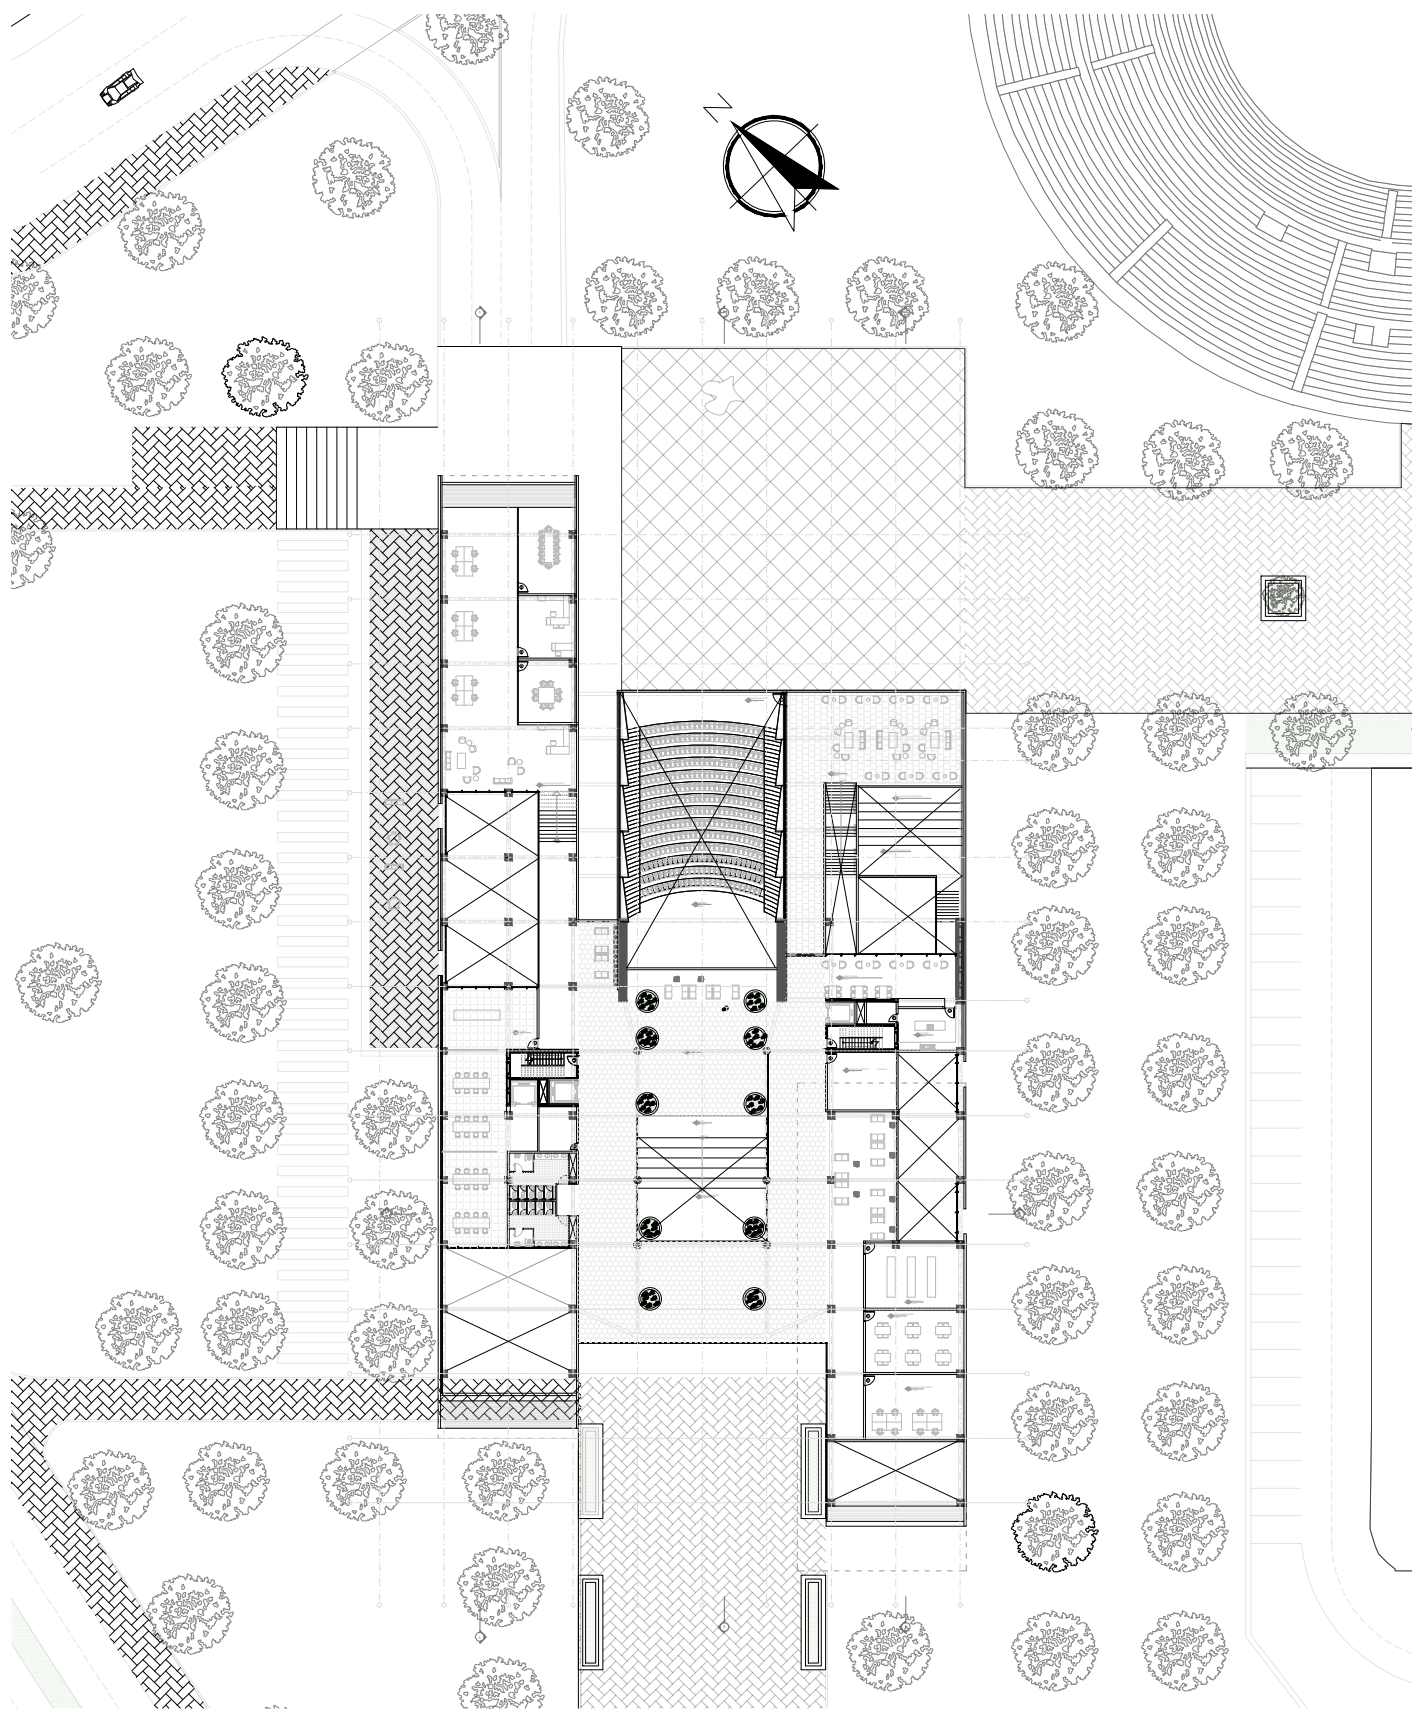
Planta Nivel 3 - CAT. Elaboración Propia.
